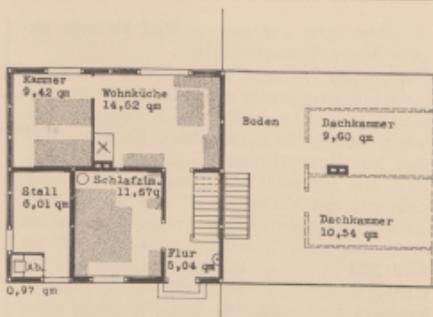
Grundrißtyp zu einer vorstädtischen Kleinfiedlerstelle, ausgeführt im Landkreis Tost-Gleiwitz.
